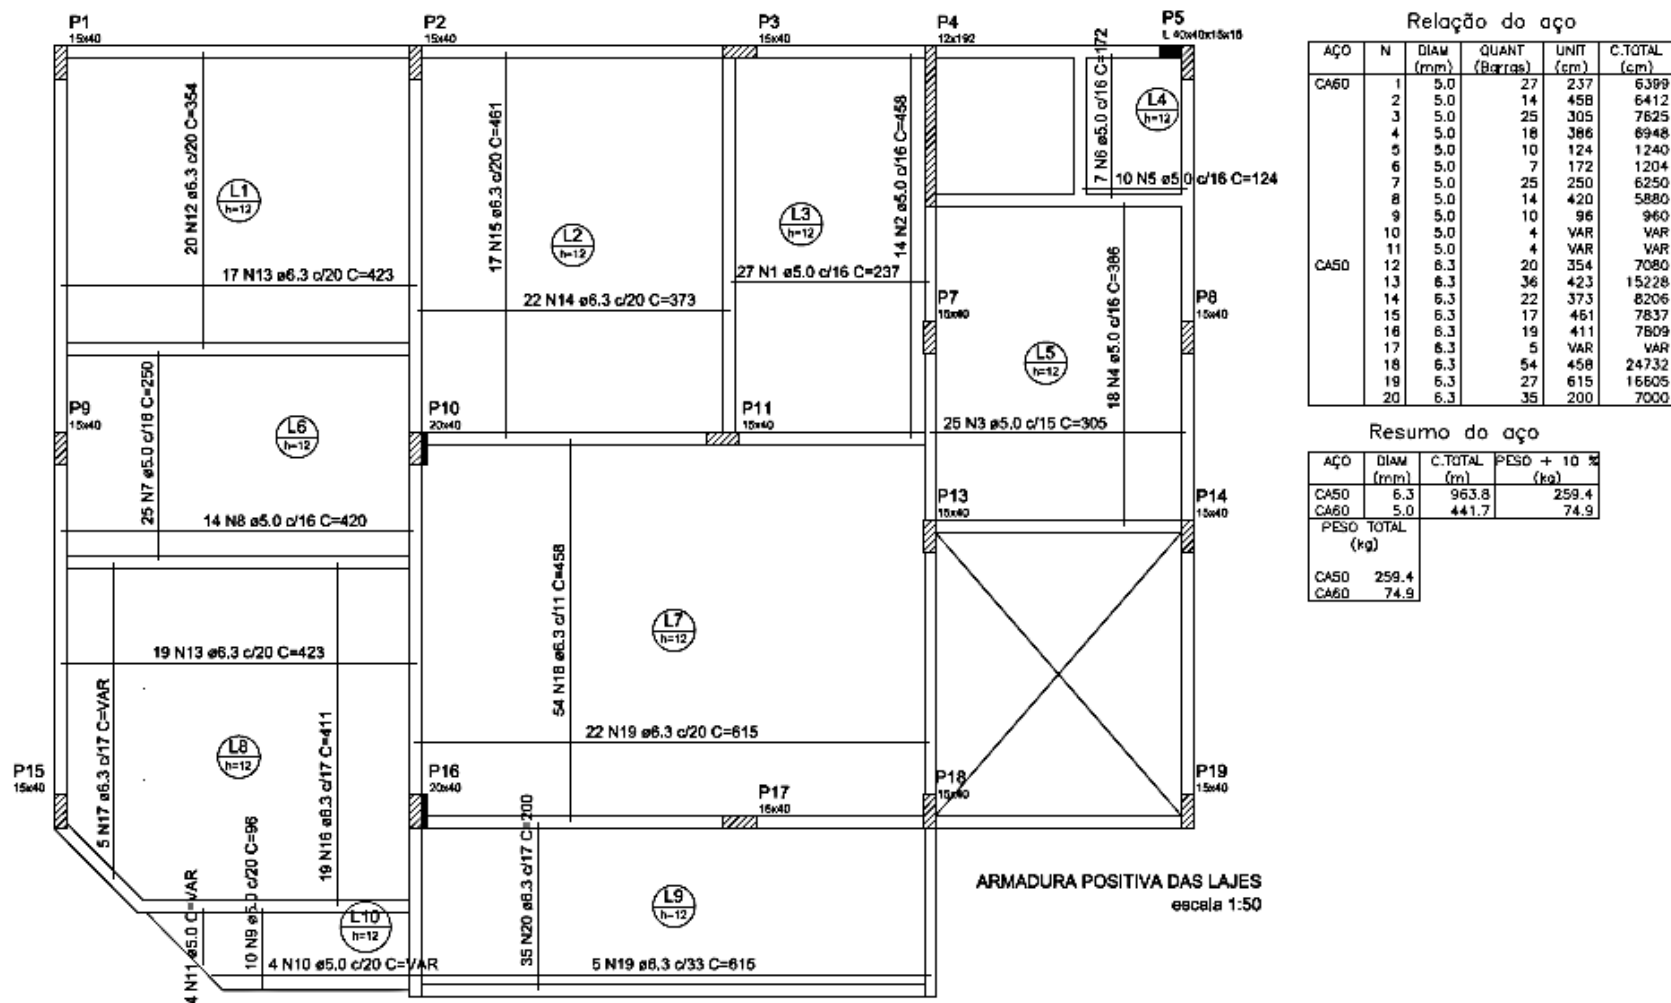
Detalhamento da armadura positiva das lajes segundo procedimentos manuais
